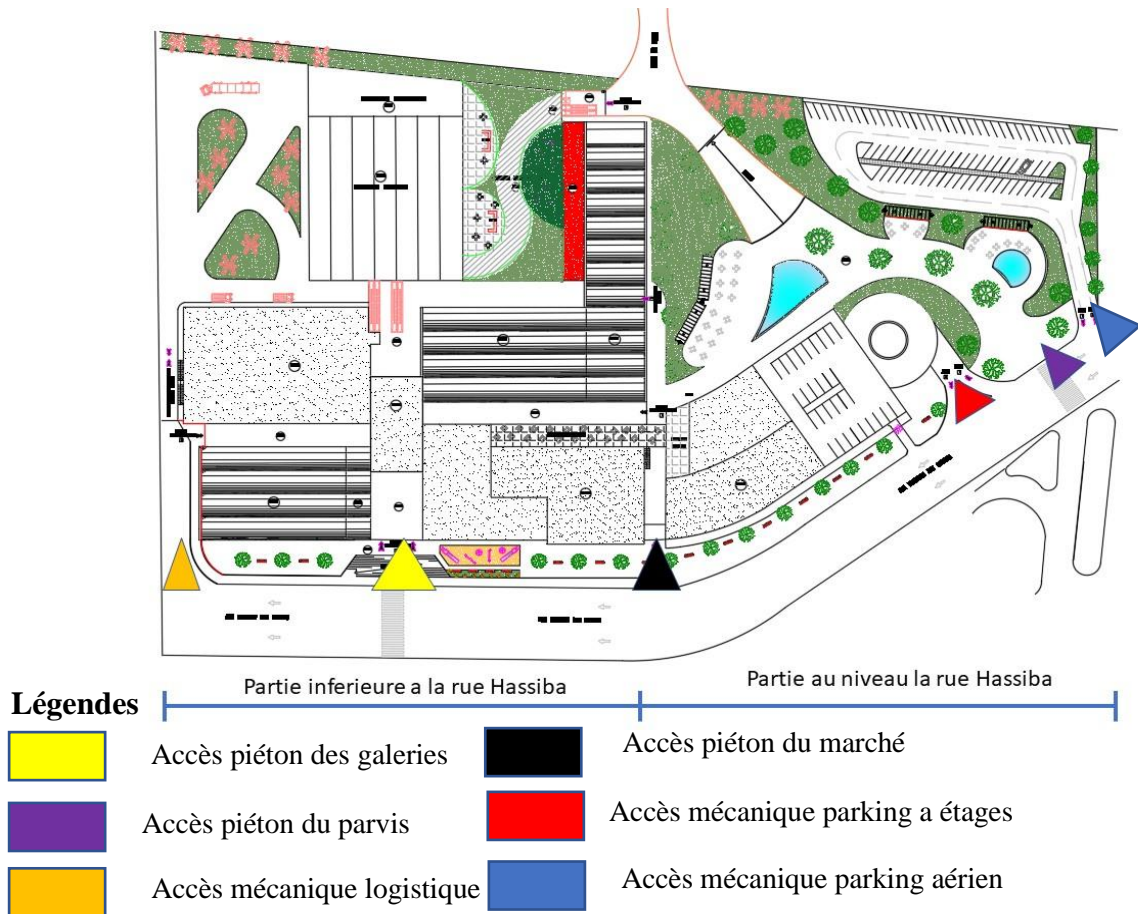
Plan de masse illustrant les accès. (Source : auteur)
